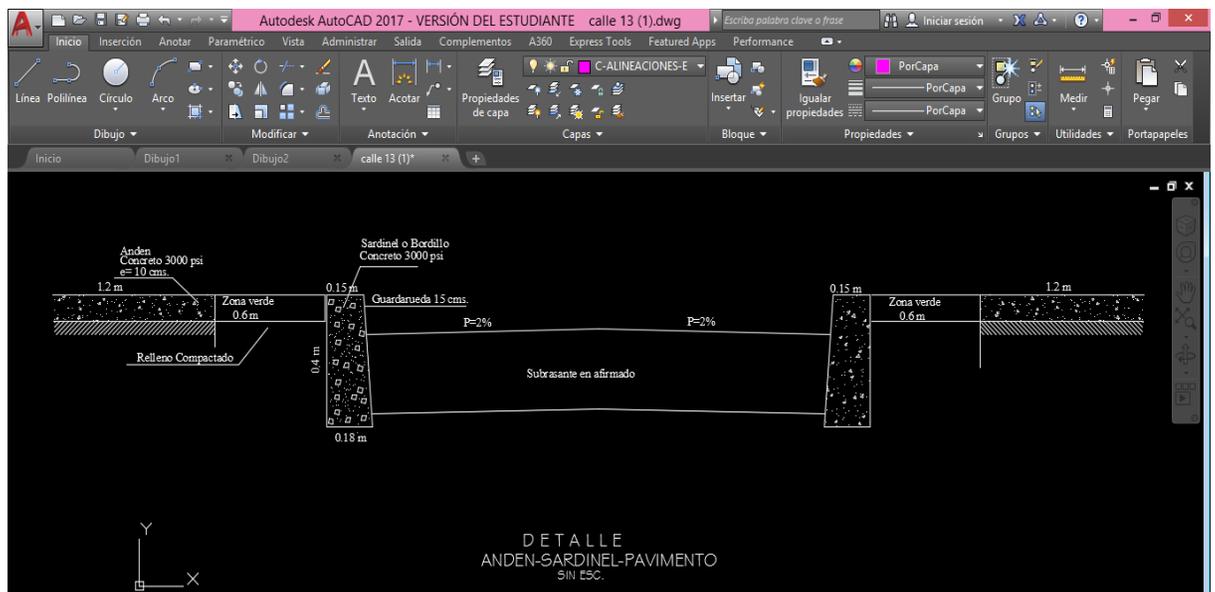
Detalle de Anden-Sardiné-Pavimento en AutoCAD
